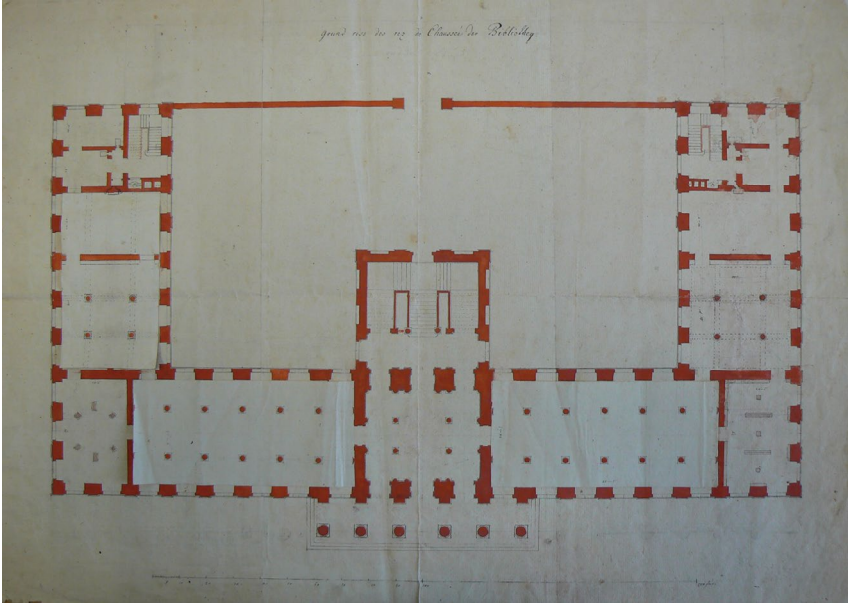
S. L. du Ry, Entwurfszeichnung zum Museum Fridericianum, ca. 1769, Grundriss des Erdgeschosses, Quelle: Stadtarchiv Kassel
